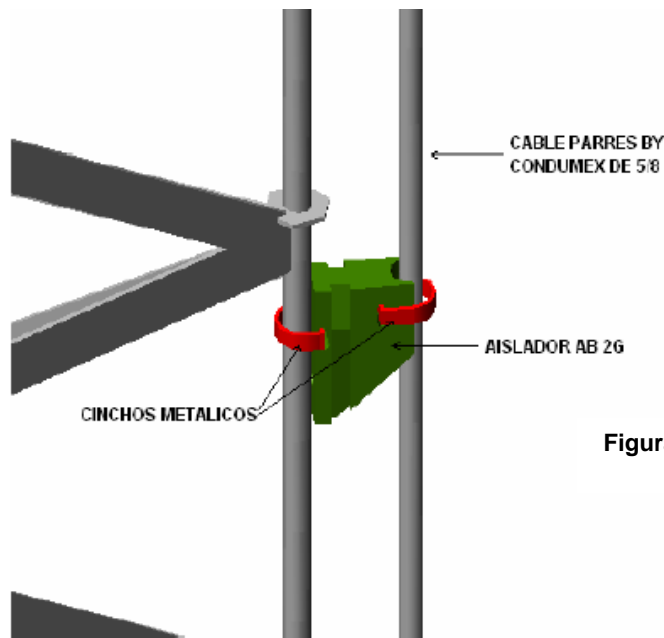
Sujeción del aislador a la estructura de la torre con cinturones metálicos
